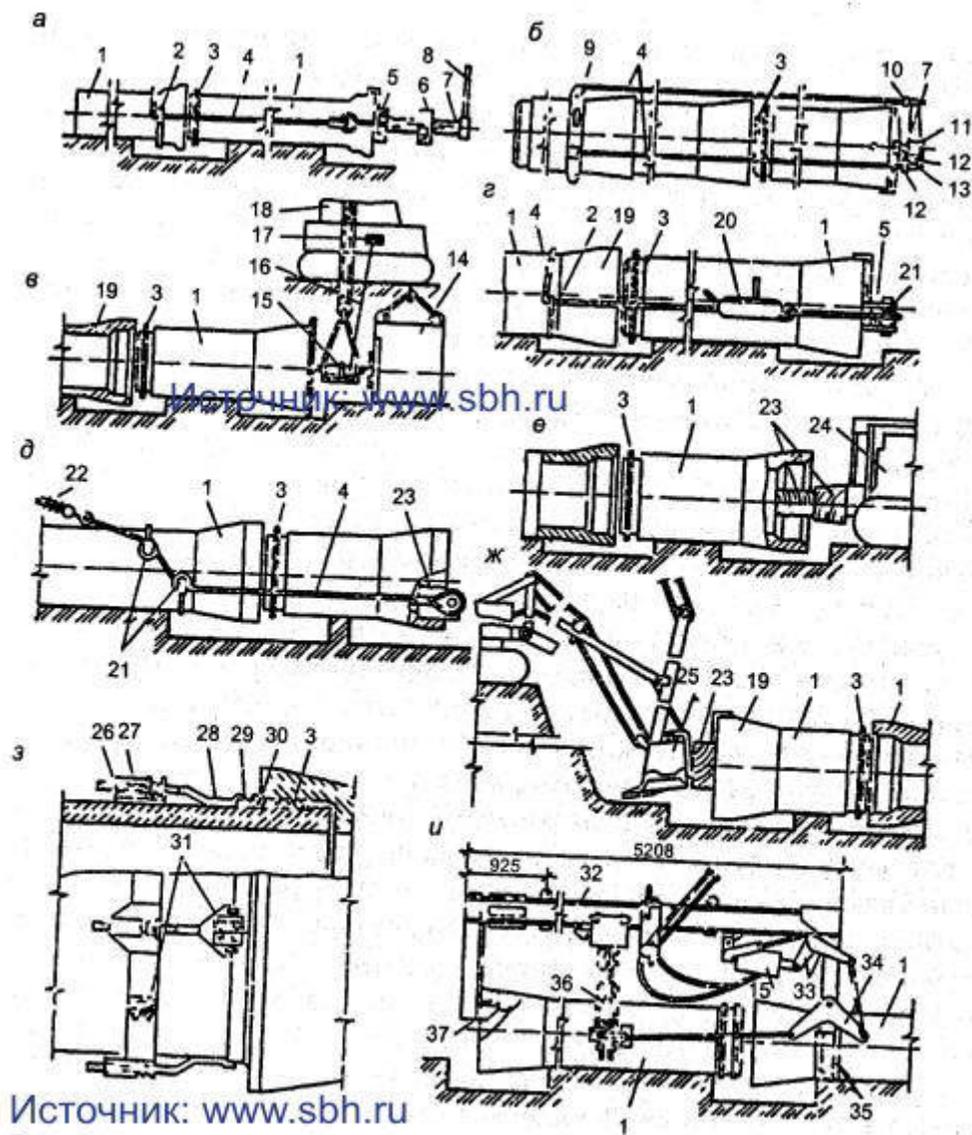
Основные рабочие операции при монтаже трубопровода из железобетонных раструбных труб:
